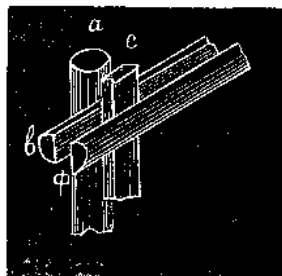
Постоянныя направляющія или рамныя сваи: а—круглая свая; в—полусхватка; с—шпунтовая свая; ф—вторая полусхватка.
